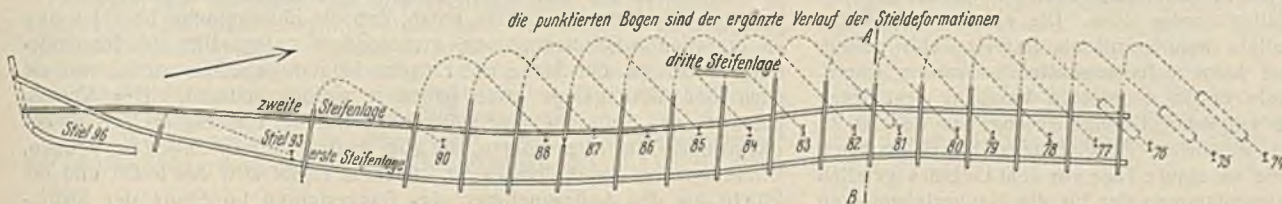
Die Lage des oberen Teils der Rammträger der östlichen Mittelwand nach dem Einbruch in Beziehung zu der vor dem Einbruch eingemessenen Stielstellung (nach photogrammetrischer Aufnahme und Einmessung des Einbruchs).
